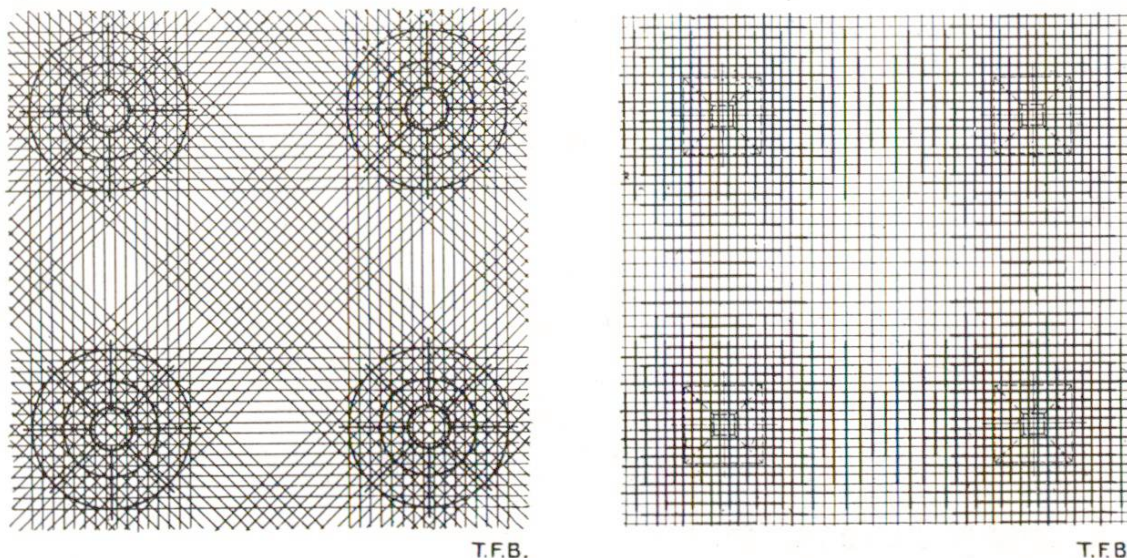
A gauche = armature orthogonale et diagonale de la dalle
